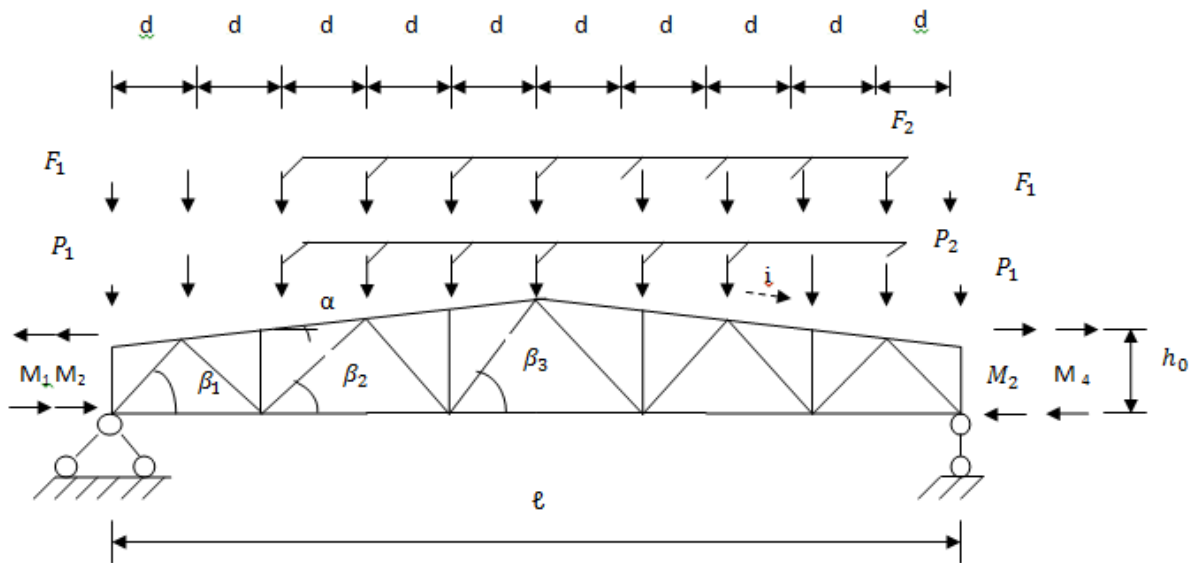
Геометрическая схема фермы – 10d. Схема вертикальных нагрузок и опорных моментов действующих на узлы фермы
